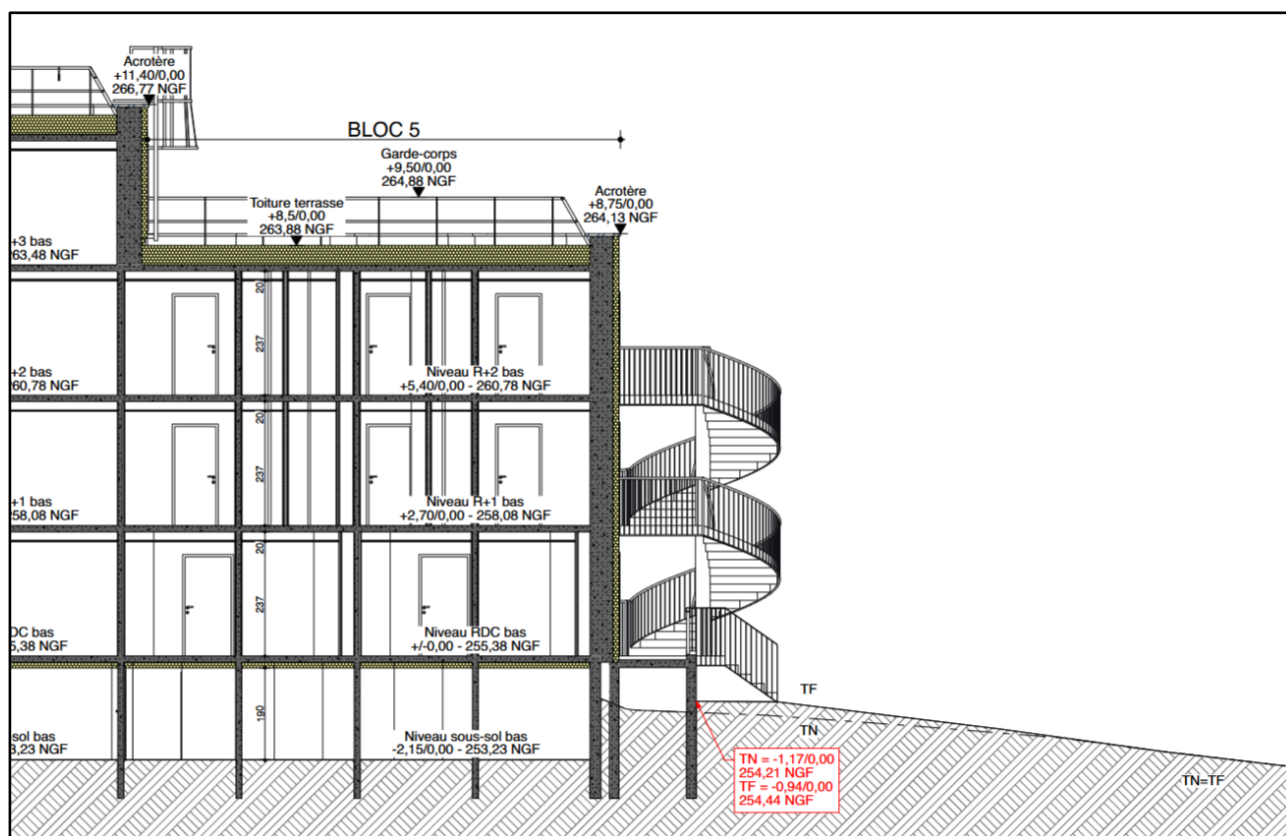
Coupe du projet d'escaliers de secours en façade Nord du bloc 5 indice A en date du 03/03/2026
